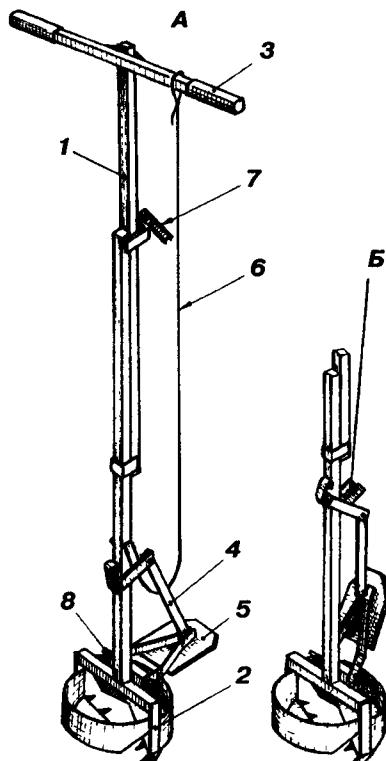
Фундаментный бур ТИСЭ-Ф:
